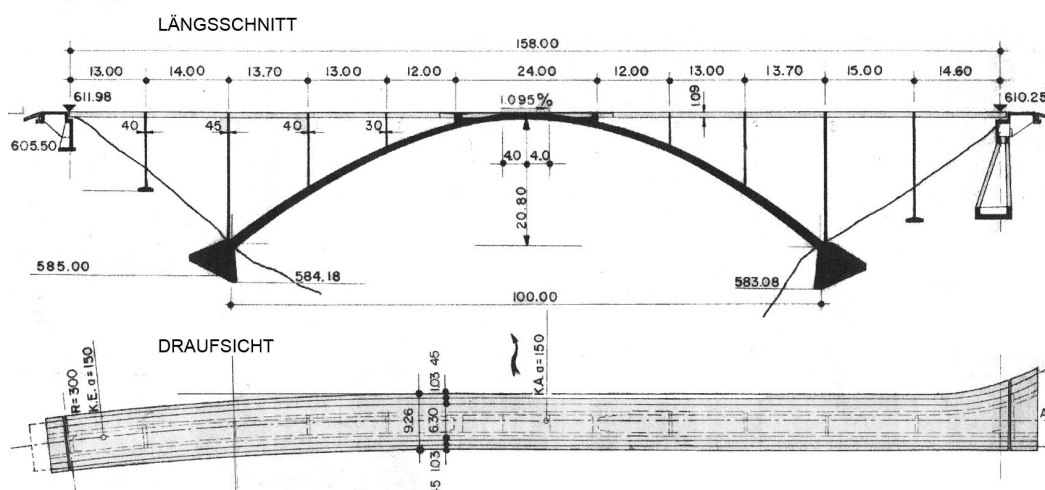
Rhein-Brücke Tamins, GR - Längsschnitt und Grundriss
